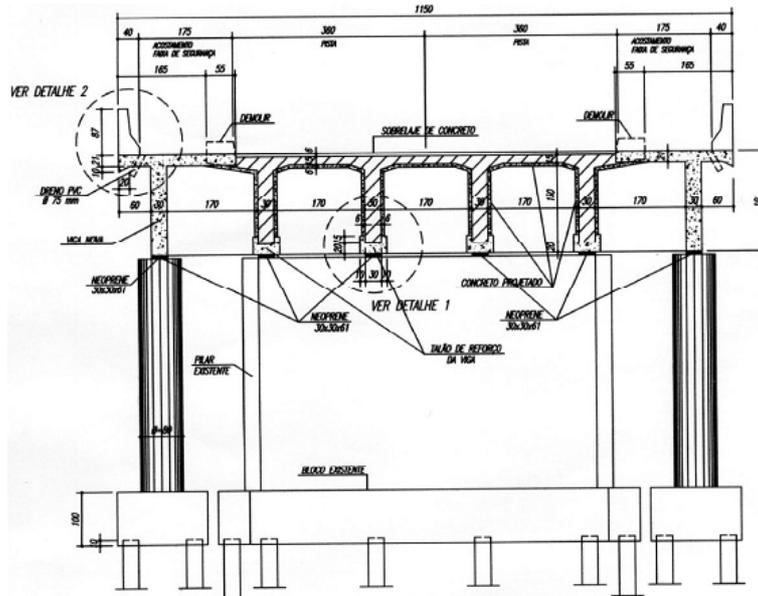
Reforço para alargamento com a adição de estacas raiz. (Fonte: VITÓRIO, 2014)
